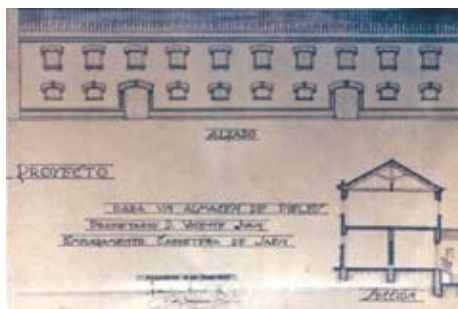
Alzado y sección Carretera de Jaén, 1925.
